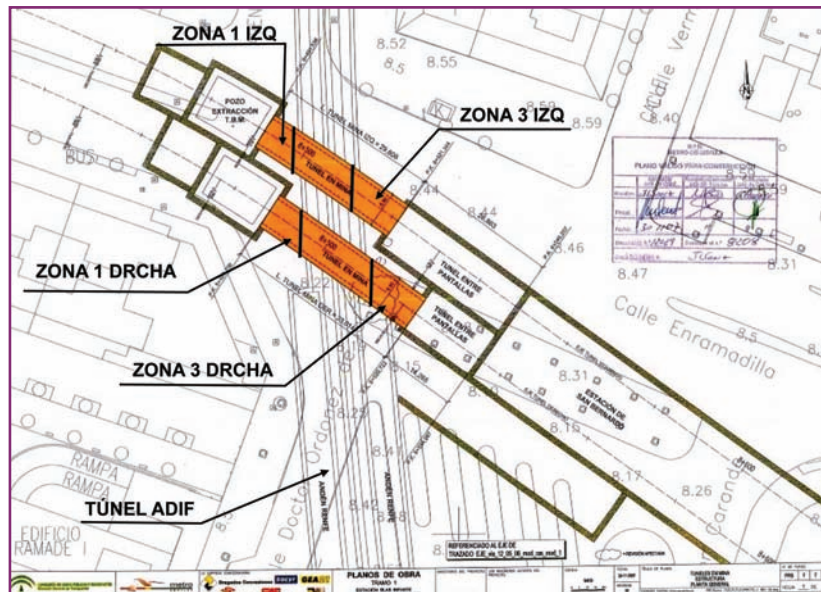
Planta general de la zona de San Bernardo en la que destacan los túneles del metro.
